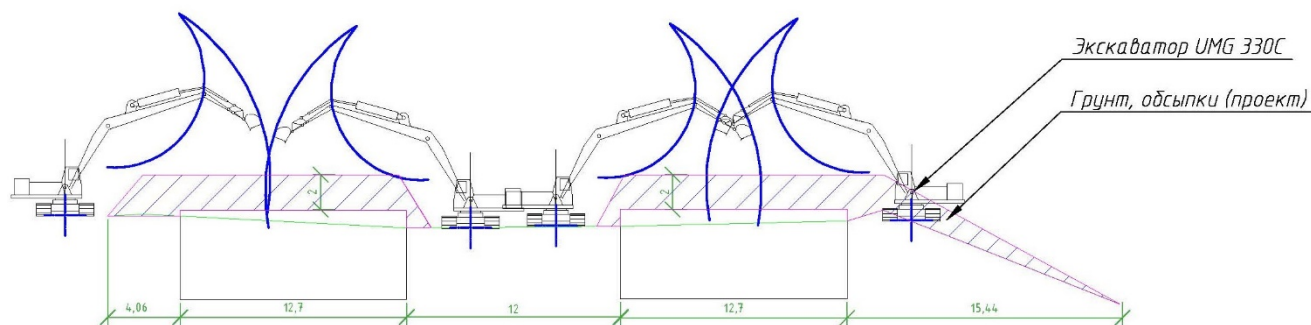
Схема обсыпки железобетонных емкостей изоляционным слоем грунта
